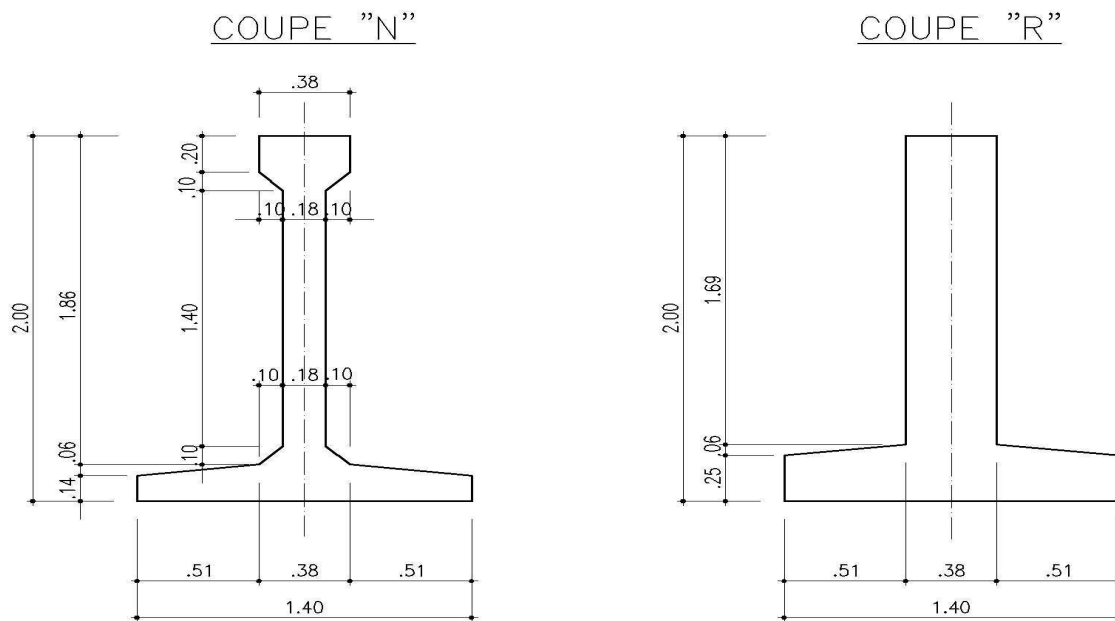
Poutre en béton précontrainte (coupe N et coupe R)
